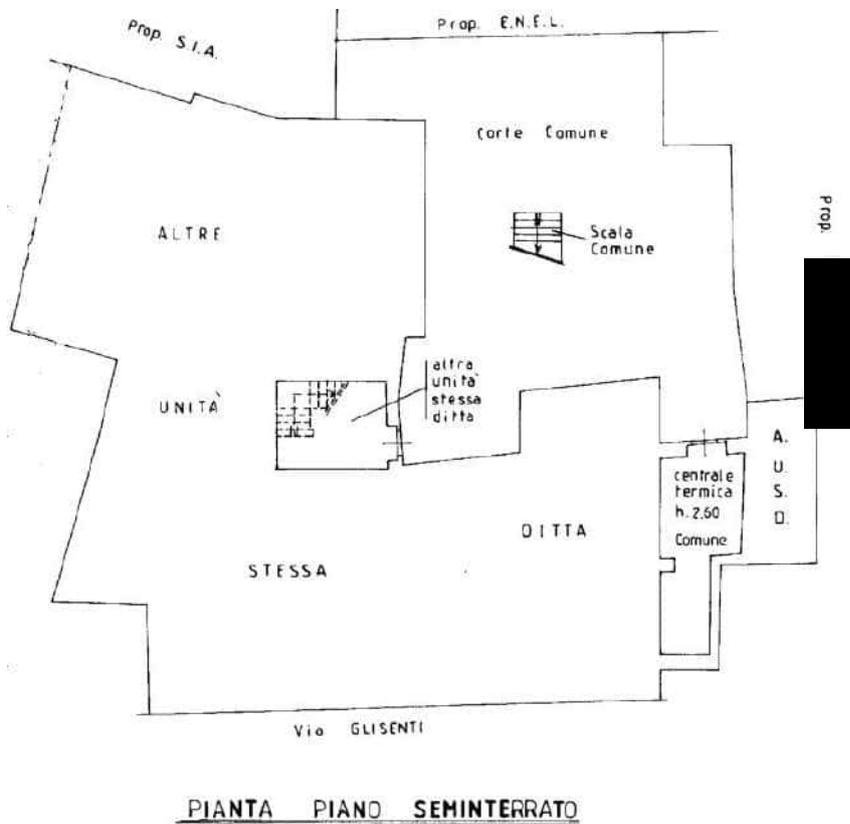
Stralcio planimetria catastale negozio – particella 299 sub. 12 – Piano Seminterrato
